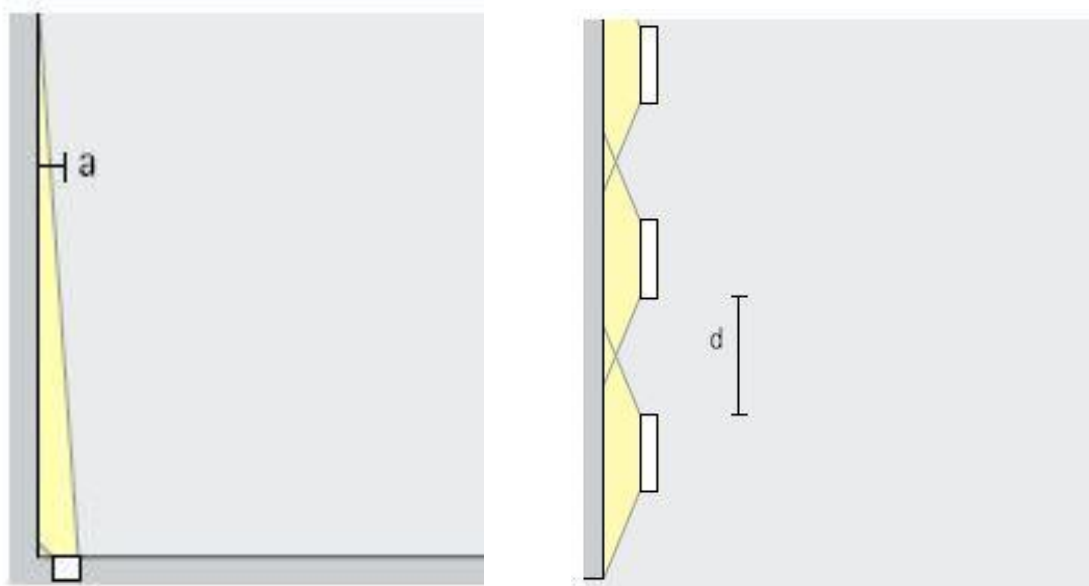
Distancia Entre La Fachada Y El Wall Washer En Sección (A La Izquierda) Y Distancia Entre Cada Wall Washer En Planta (A La Derecha)
